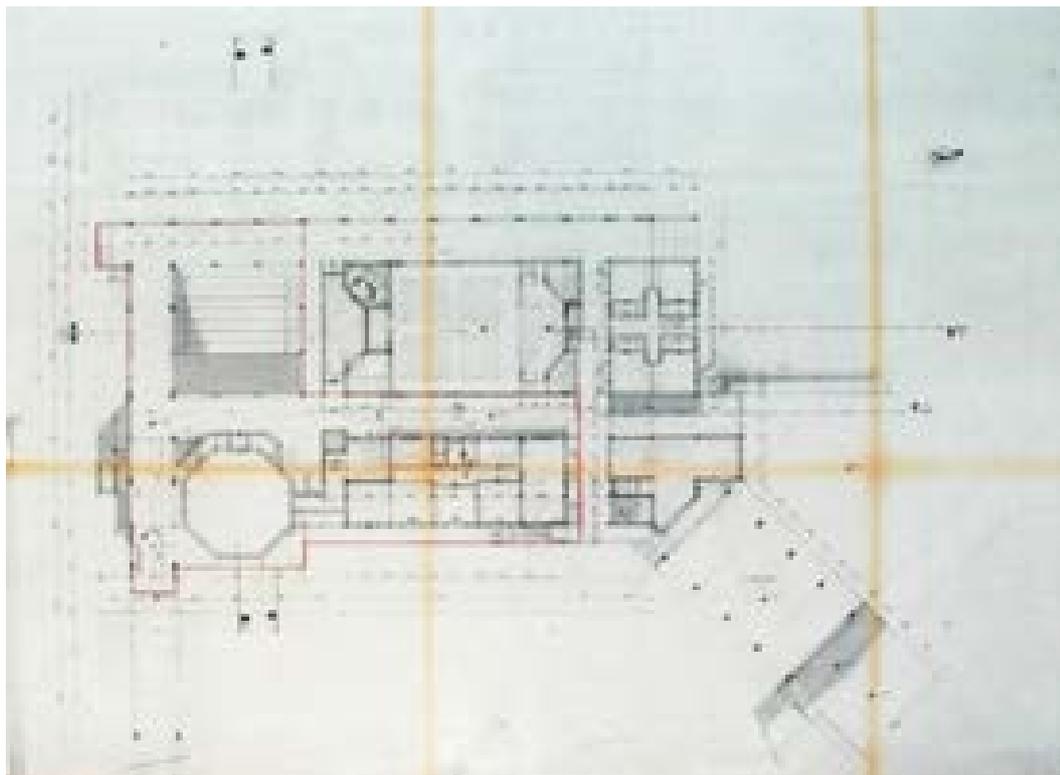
Pianta +1,00, stato sovrapposto – 26/07/1994 (AABS-64_670)
